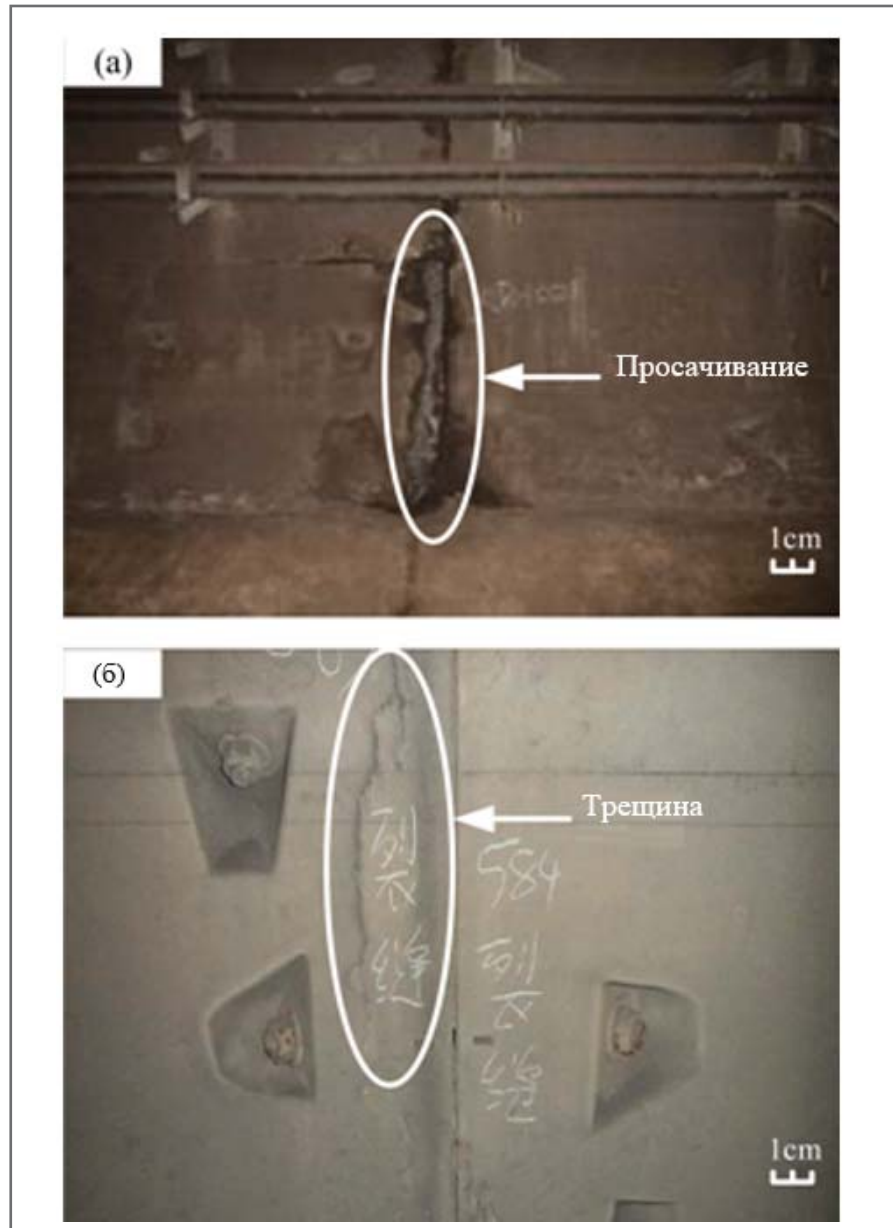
Нарушения в конструкции тоннеля перед началом возведения фундамента (а) тоннельное просачивание (б) тоннельная трещина
